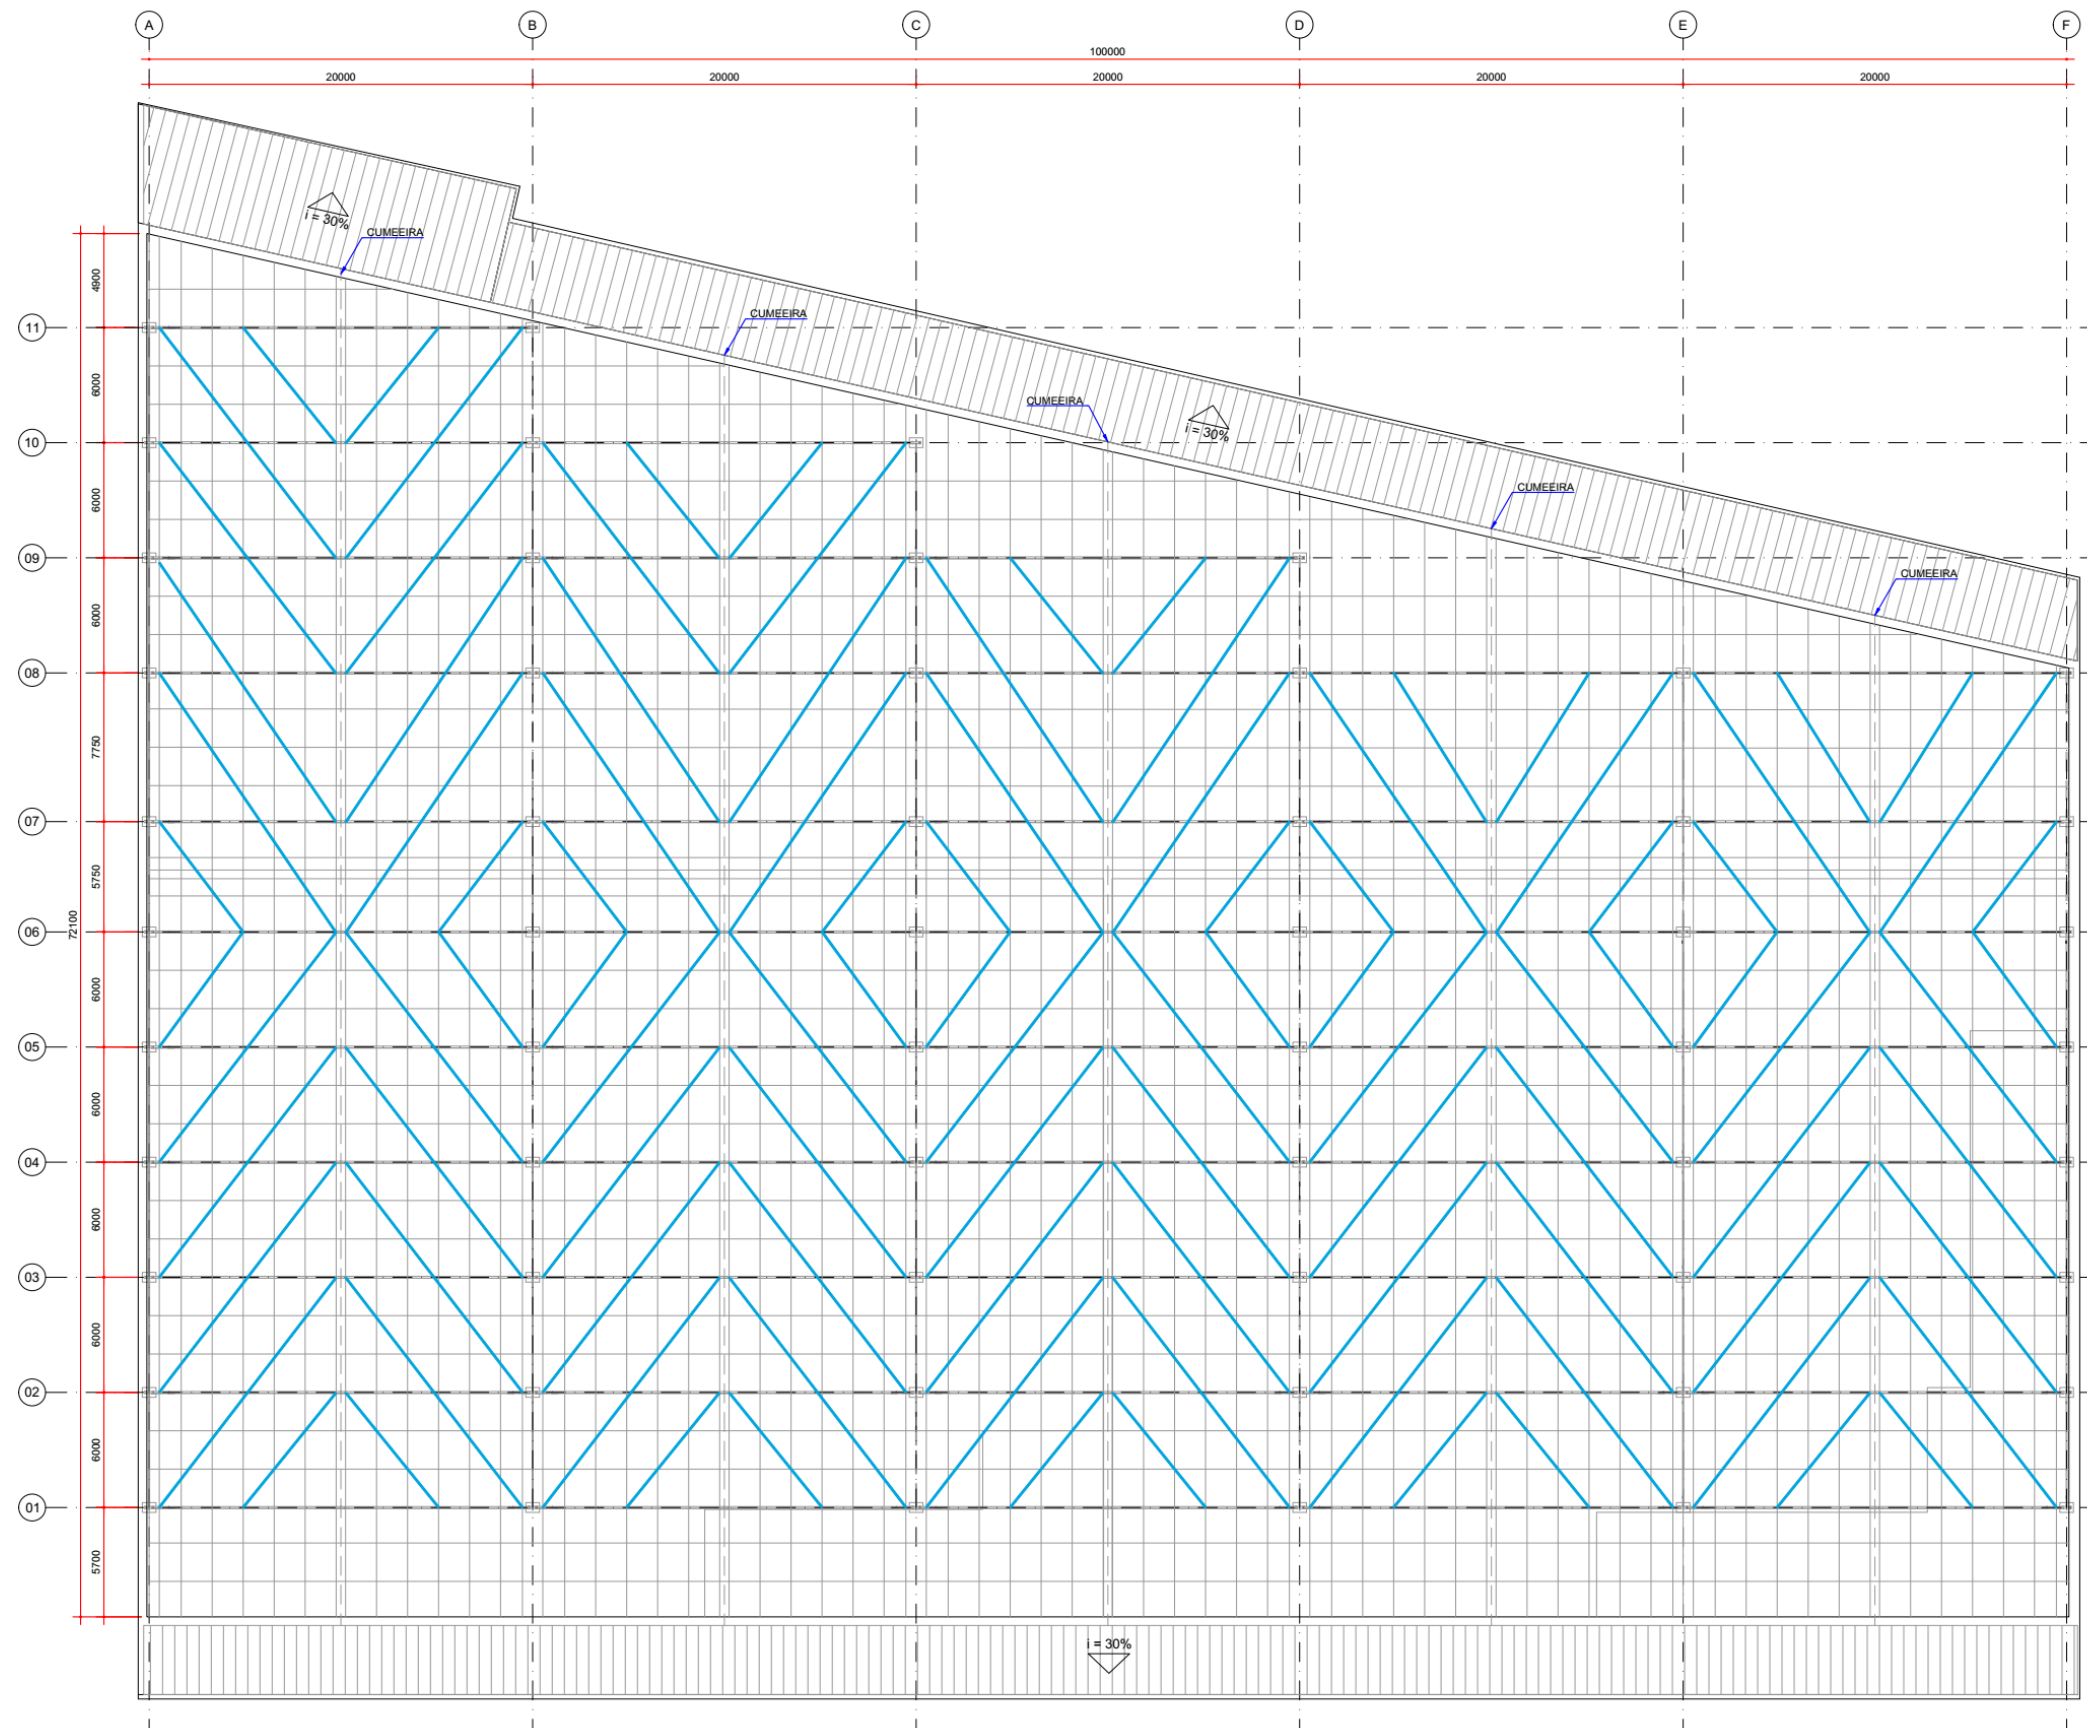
LOCAÇÃO DOS CONTRAVENTAMENTOS (DIMENSÕES EM MM)
